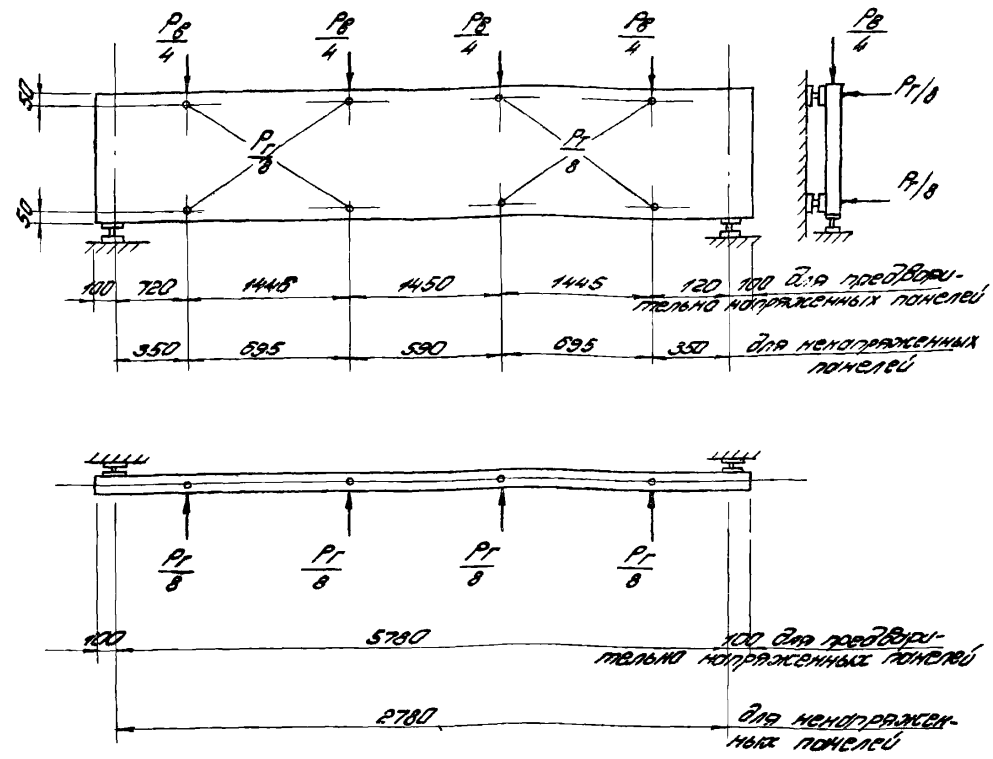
Схема приложения нагрузок при испытании стеновых панелей.
